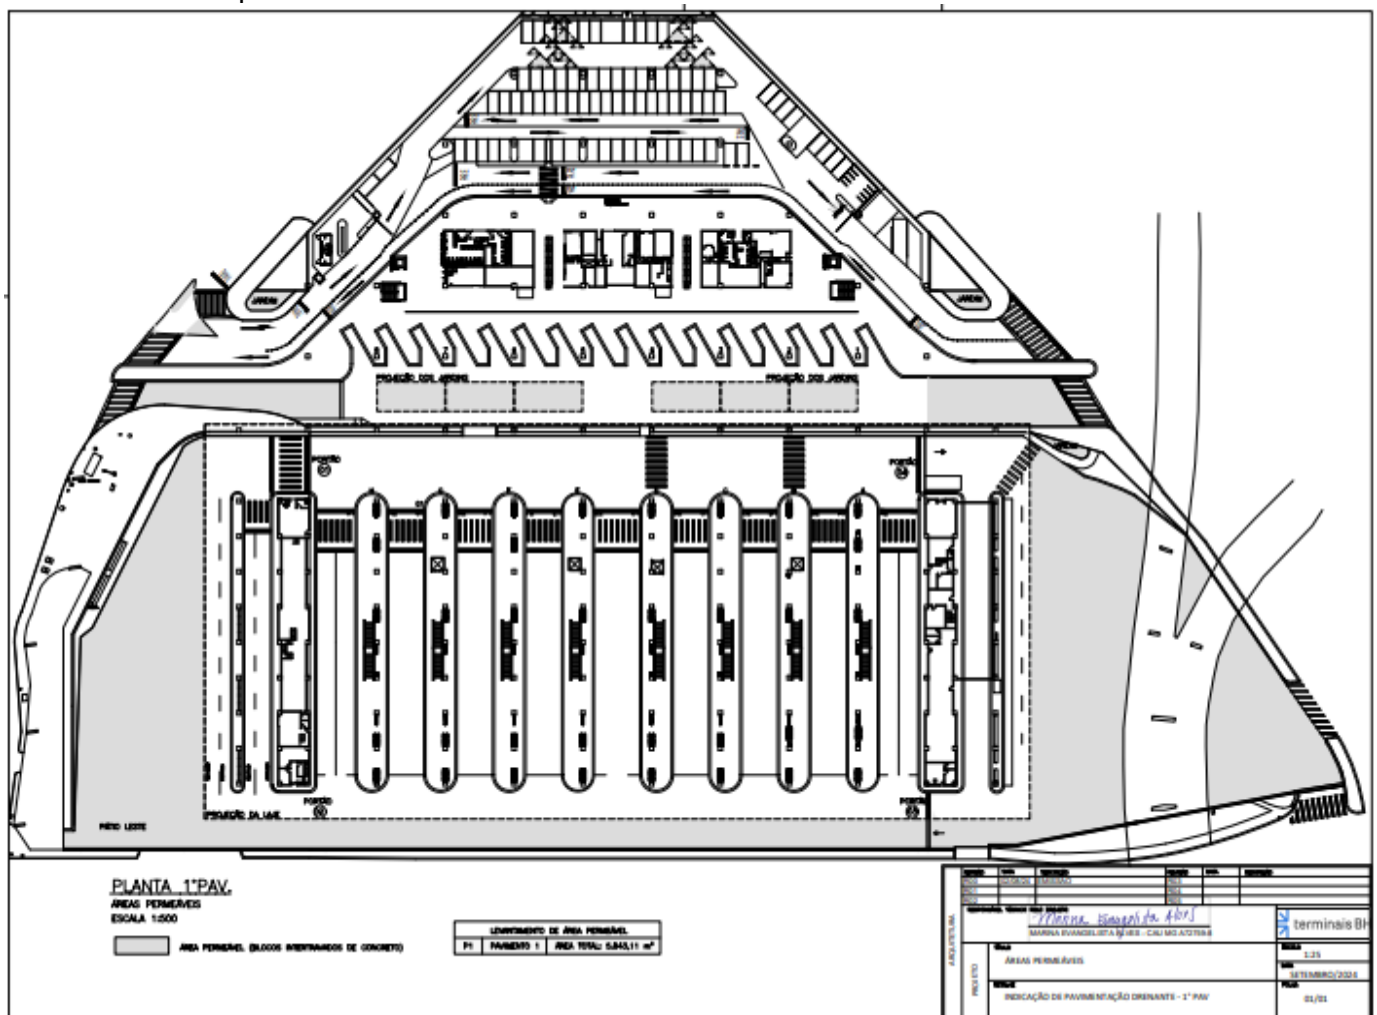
Planta 1º pavimento – 2025 – planta fl. 01/01 – setembro/24
